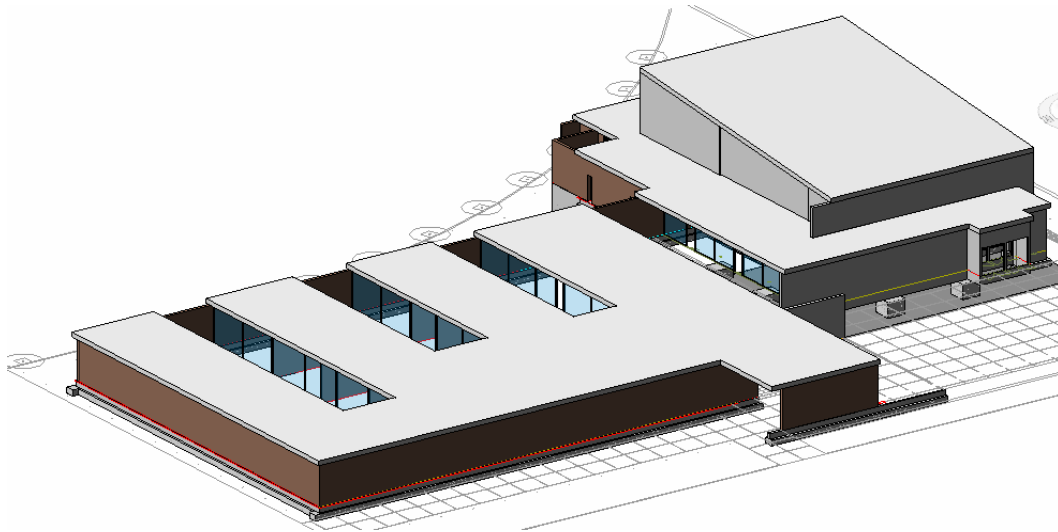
Perspectiva del modelo realizado donde se aprecian las cubiertas de ambos edificios.
